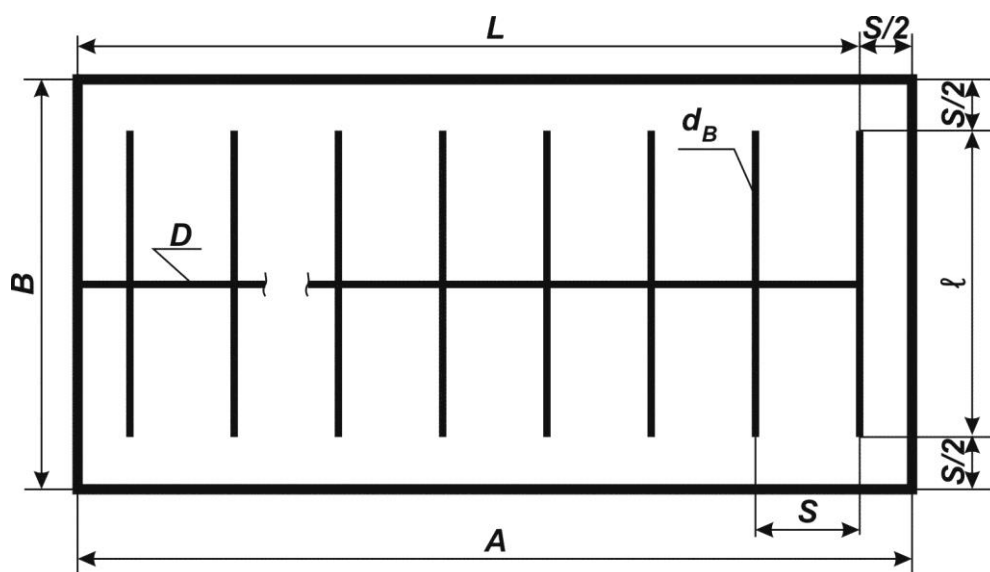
Схема размещения трубопроводов в защищаемом помещении
